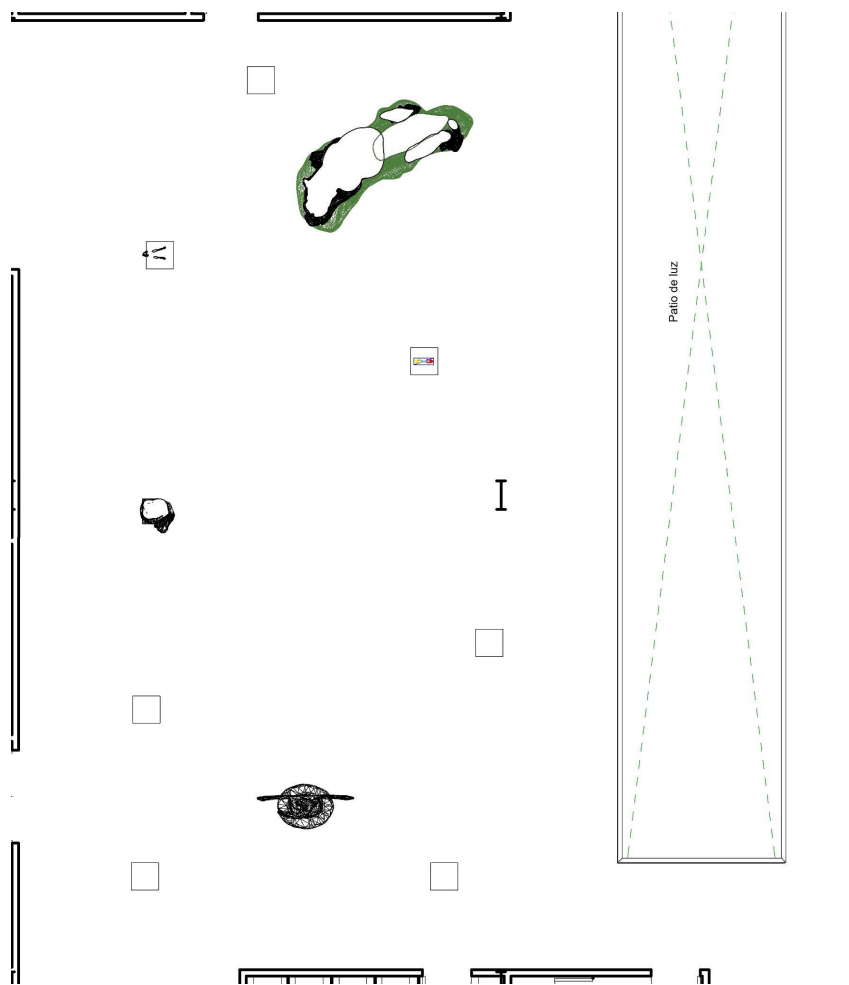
Detalle de la planta de galería. Fuente propia.
